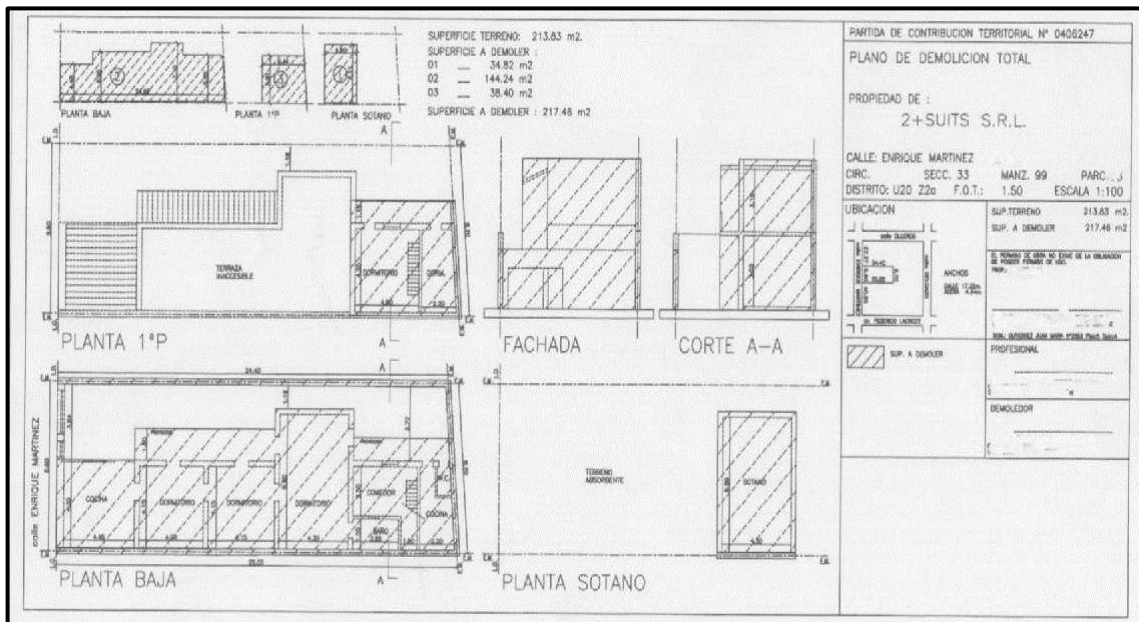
Pruebas de Medianería: Plano de Demolición
